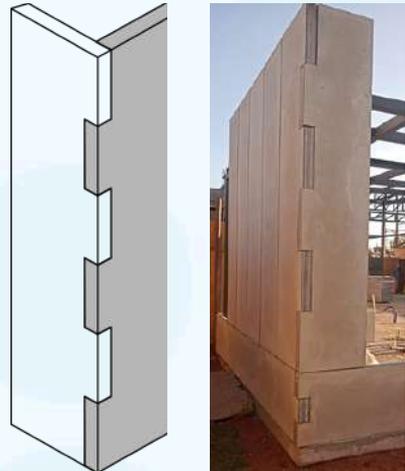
Ligação do tipo trama entre painéis Lightwall®
